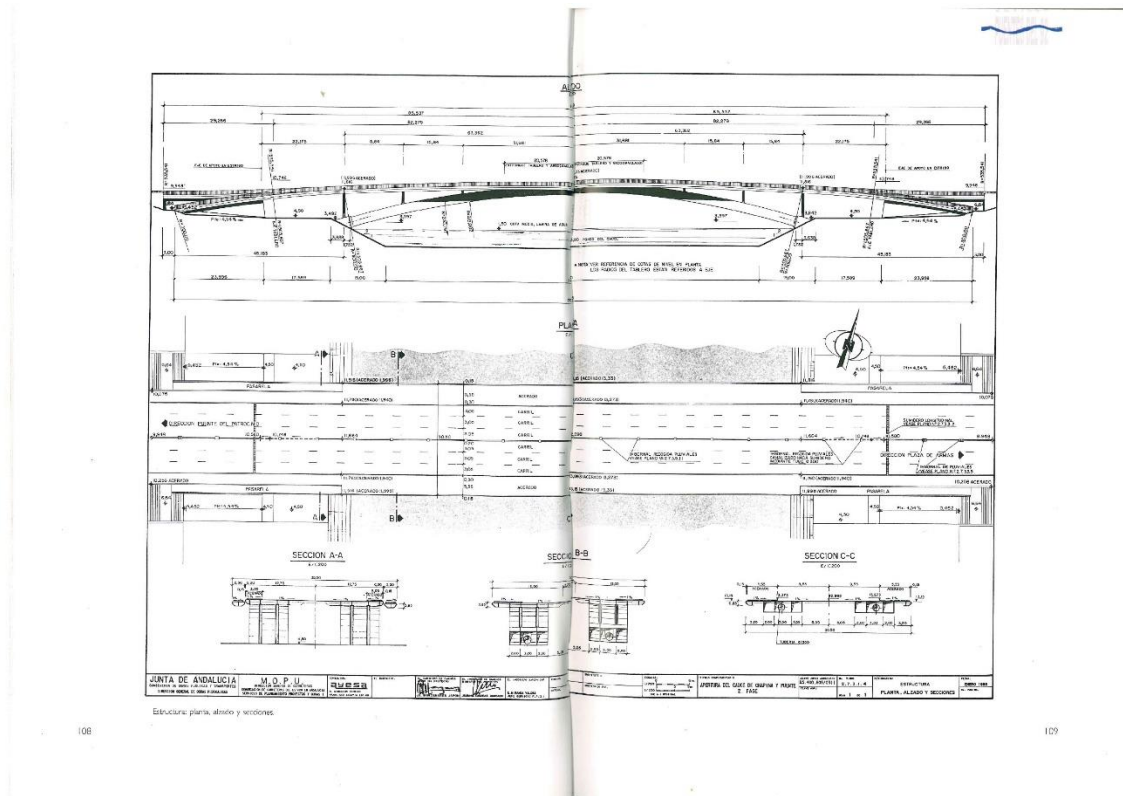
Vista de los planos longitudinal y en planta encontrados.
